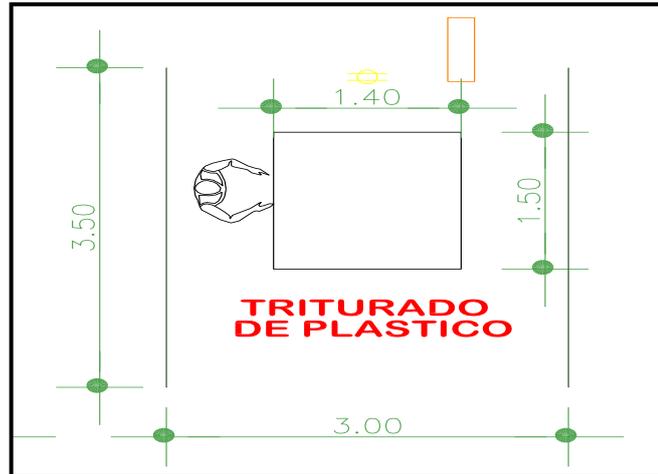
Vista arquitectónica específica del área de triturado plástico
